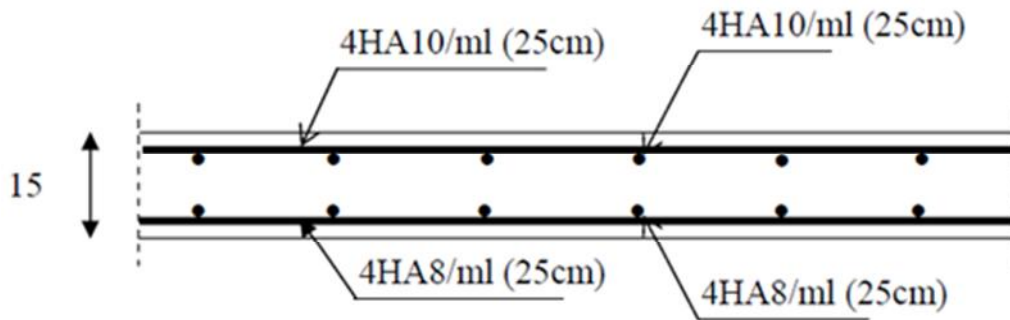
Schéma du ferrailage de la dalle pleine de la salle machine.
